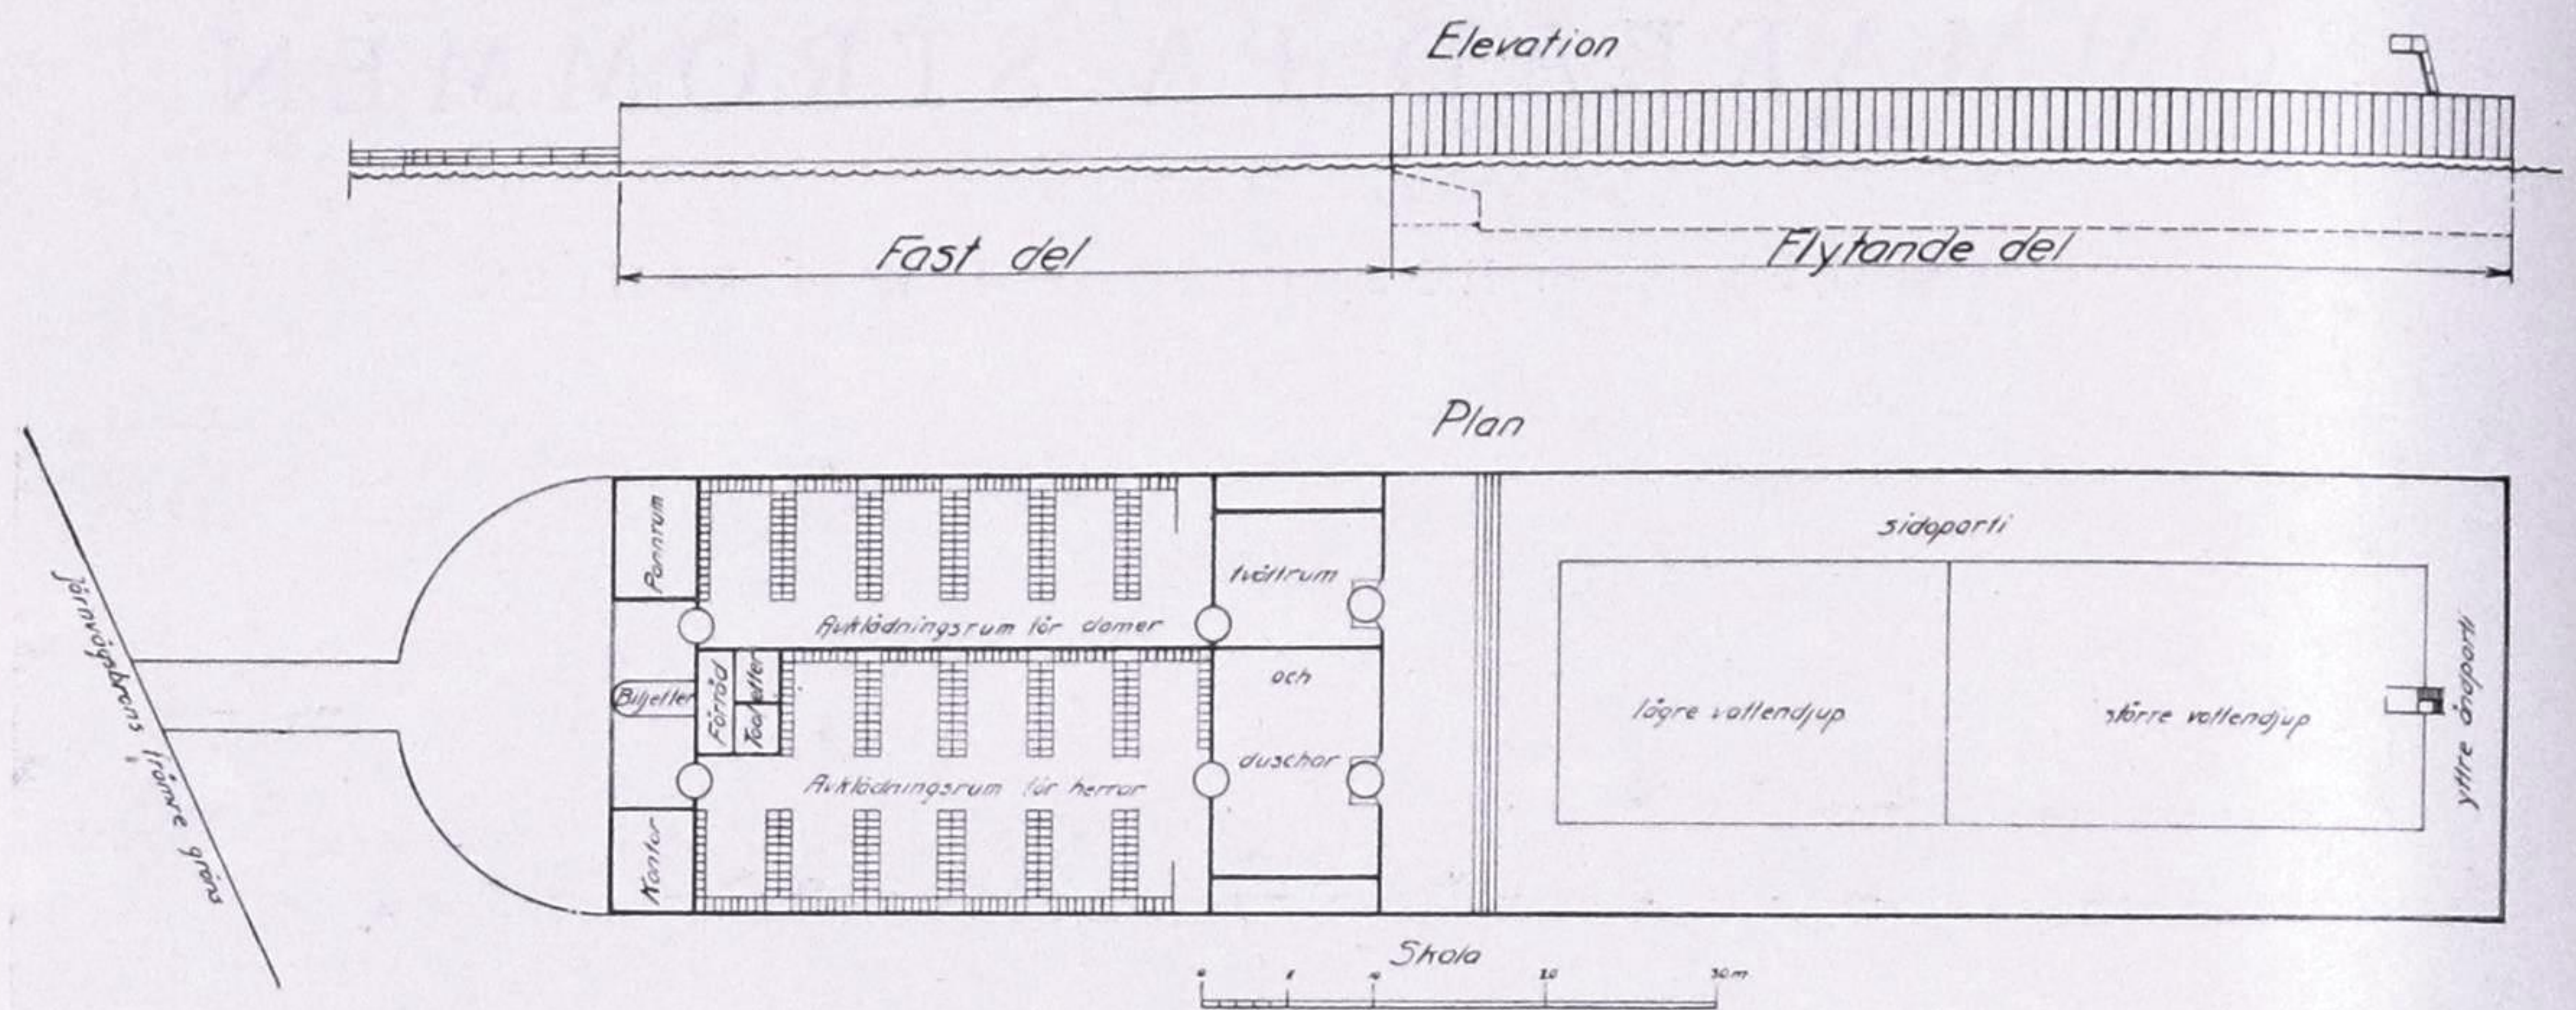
Plan och elevation av sommarbadet på Strömmen med glasväggar såsom vindskydd kring bassängen.
